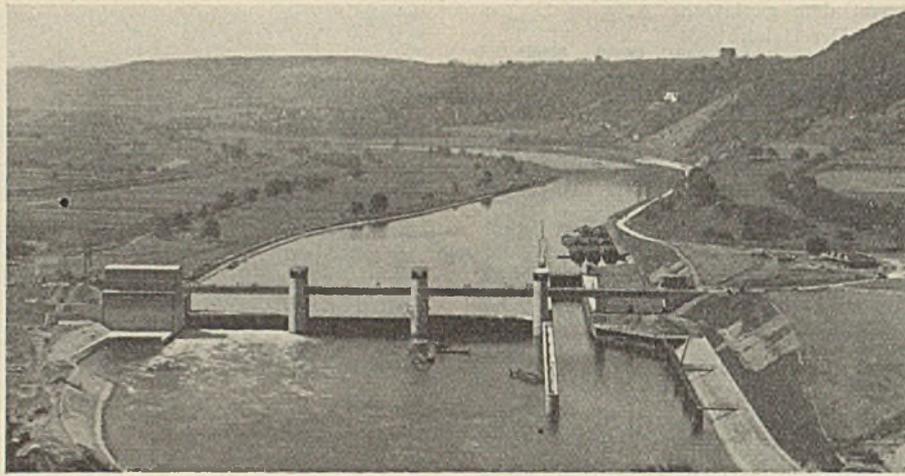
Staustufe Gündelsheim, Unterwasserseite.
